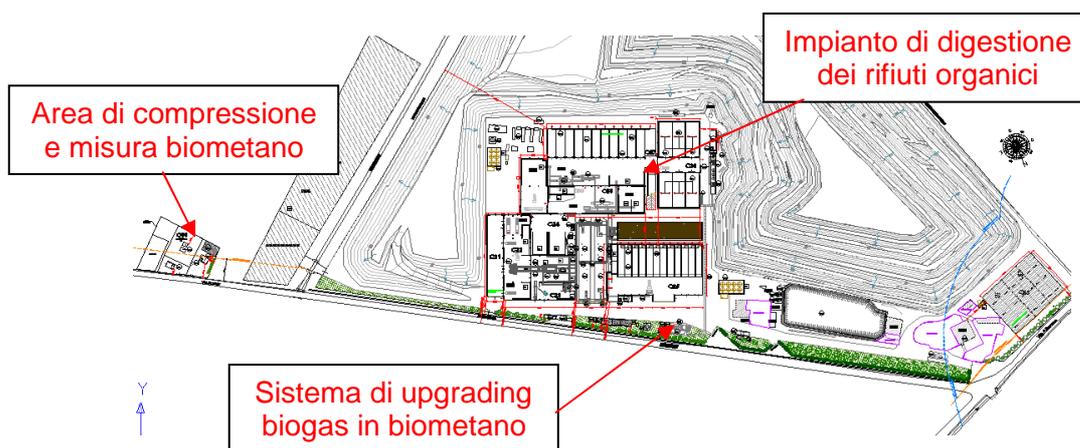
Estratto della planimetria di progetto (Stralcio dell'Elaborato 4 del Progetto Definitivo)
